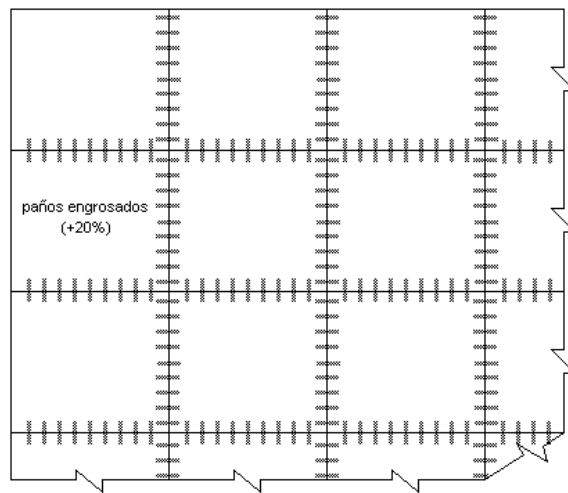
Tratamiento de paños perimetrales en pavimentos industriales
